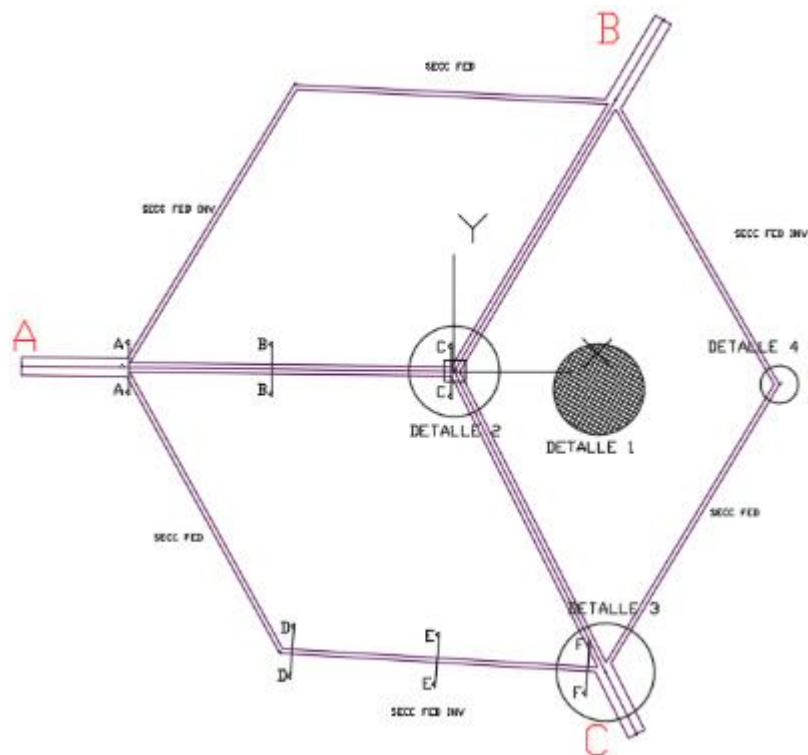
Vista 3D del paraboloide FIC-UNI/ Vista perspectiva 0°
